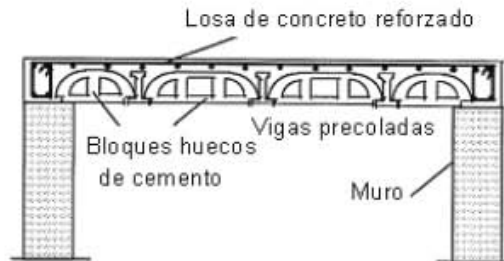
Sistema de losa viga-bloque (Aguilar et al., 1996)
